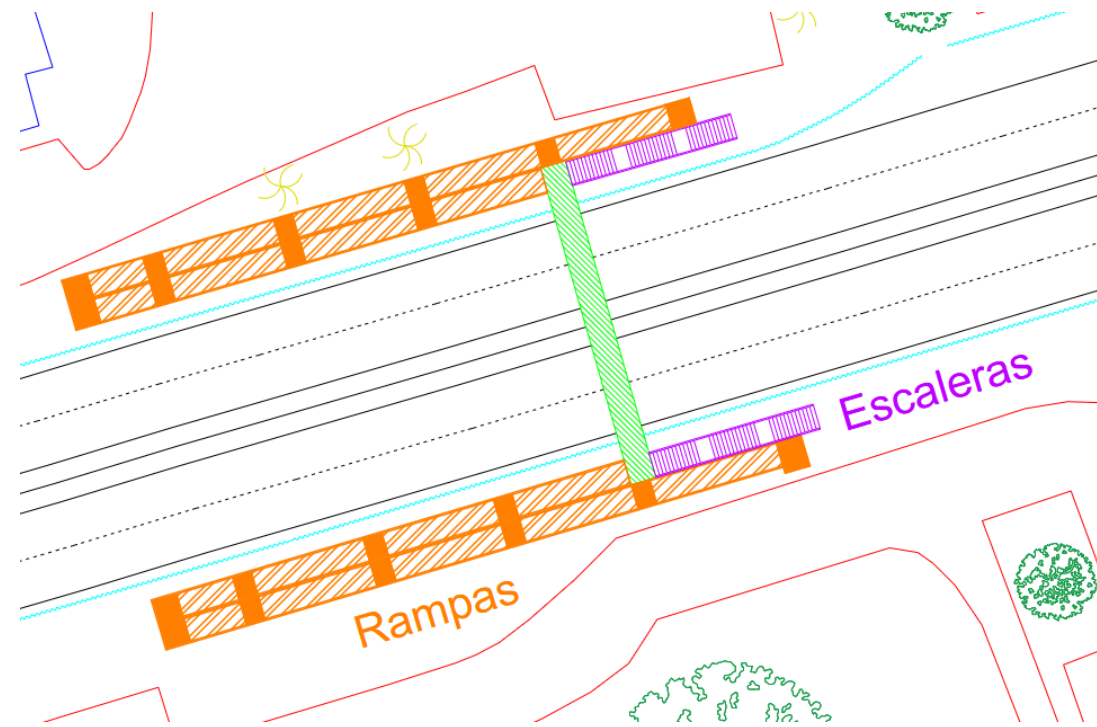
Posición de las rampas y escaleras en planta; Fuente: Elaboración propia
